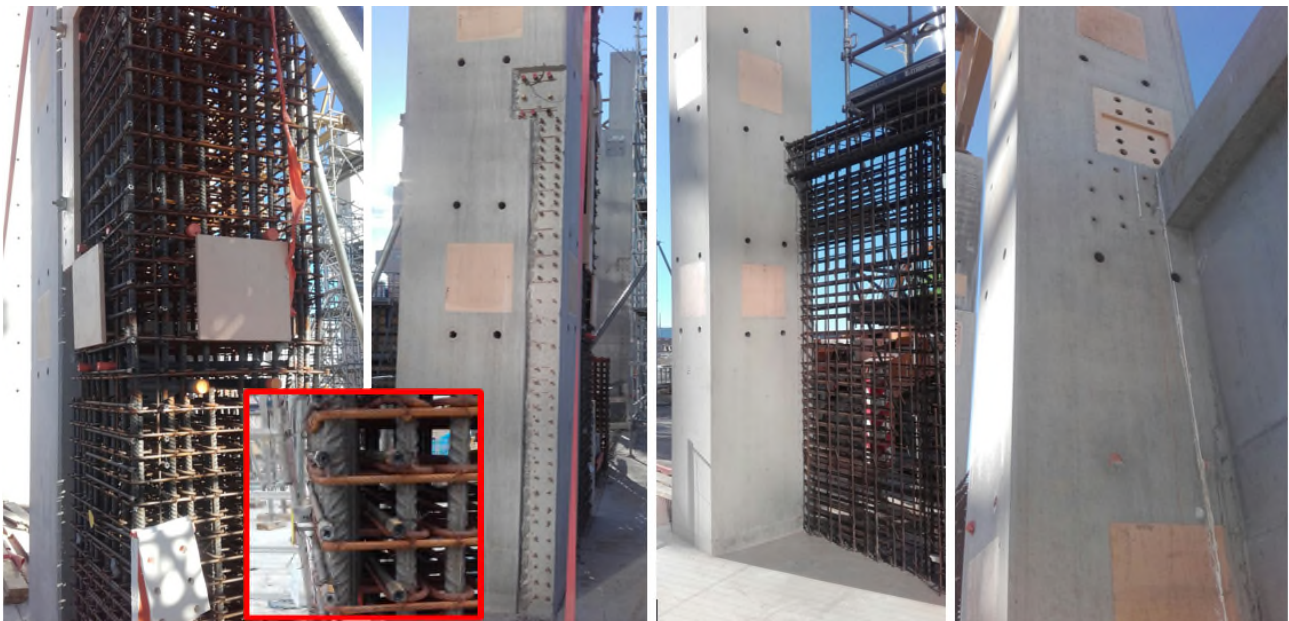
Fases constructivas de los pilares y el muro en la fachada norte.
